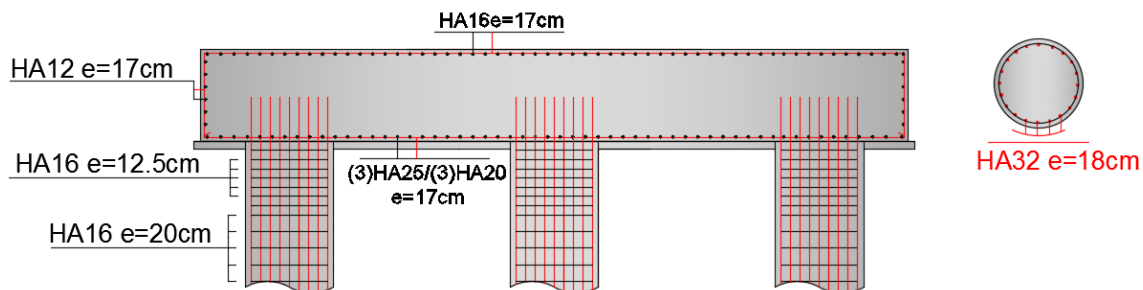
Ferrailage des pieux et semelle des piles.
